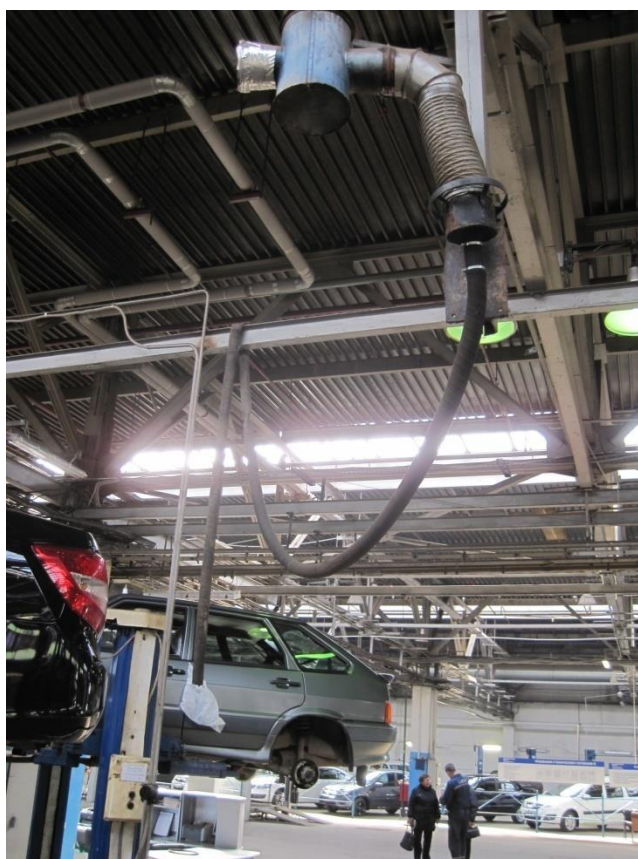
Насадки на трубах вентиляции отсутствуют
